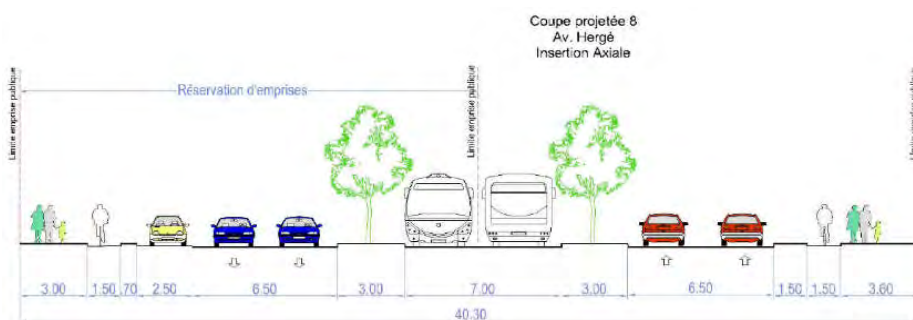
Coupe projetée sur l'avenue Hergé – Source : SYSTRA
